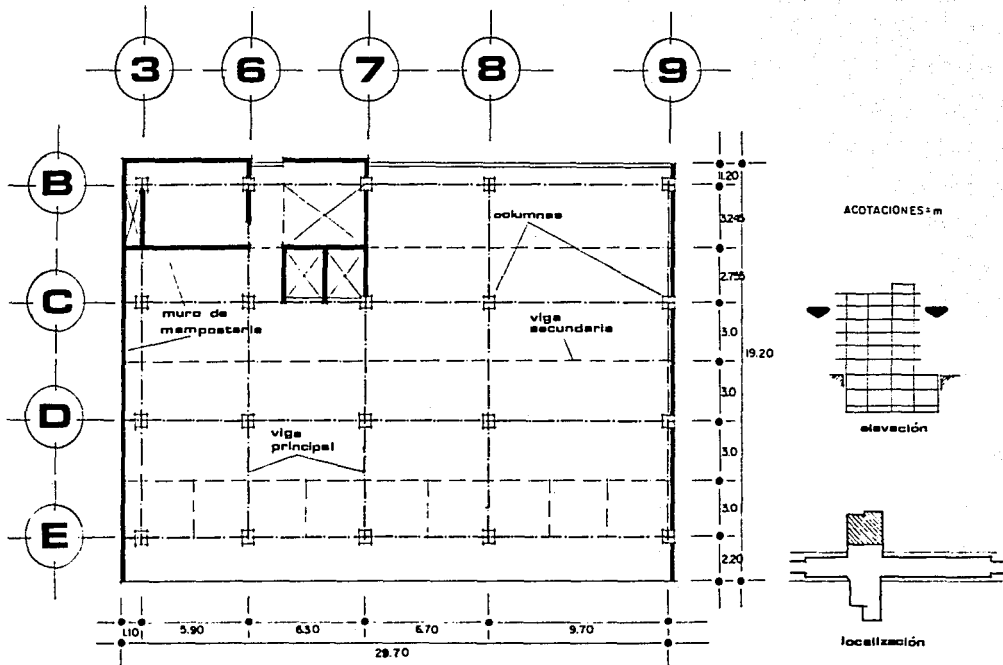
PLANTA DE LOS NIVELES 1 A 5
